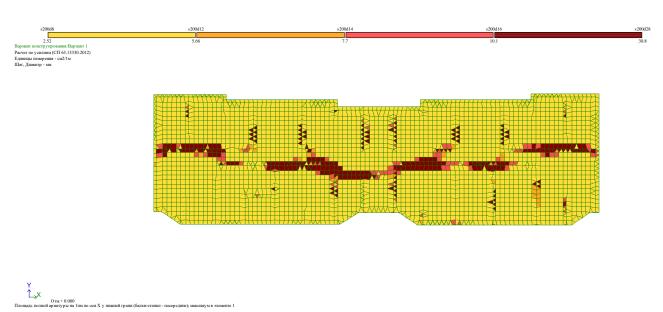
Фундаментная плита на отм. -4.000. Нижнее армирование вдоль оси X
